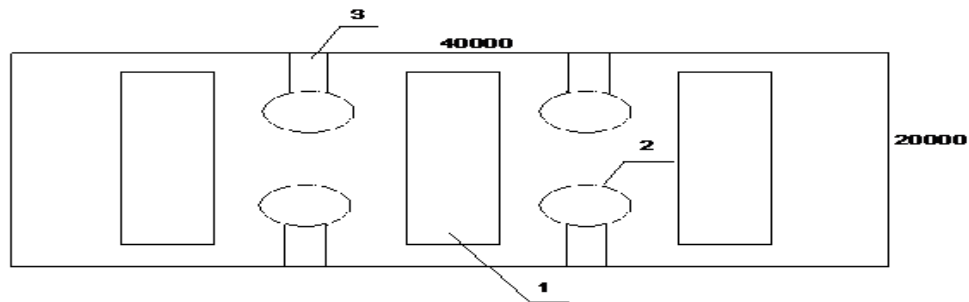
Схема размещения вентиляций: 1 –резервуар СПГ;
